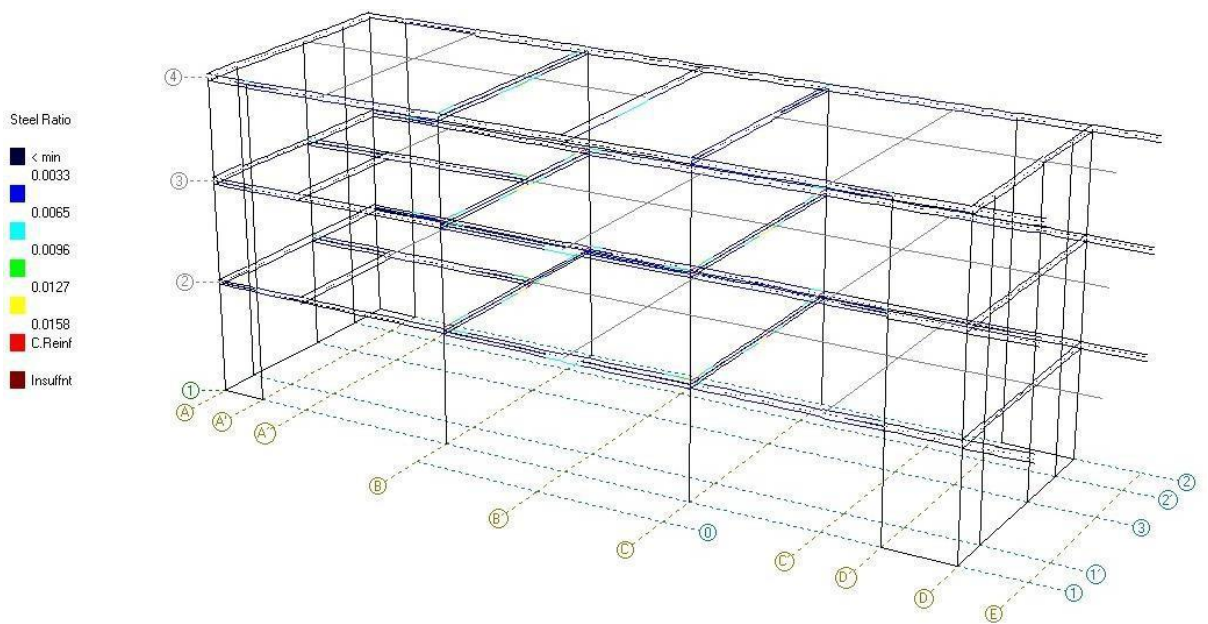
Esfuerzos en vigas reforzadas. Elaborada por el autor.
